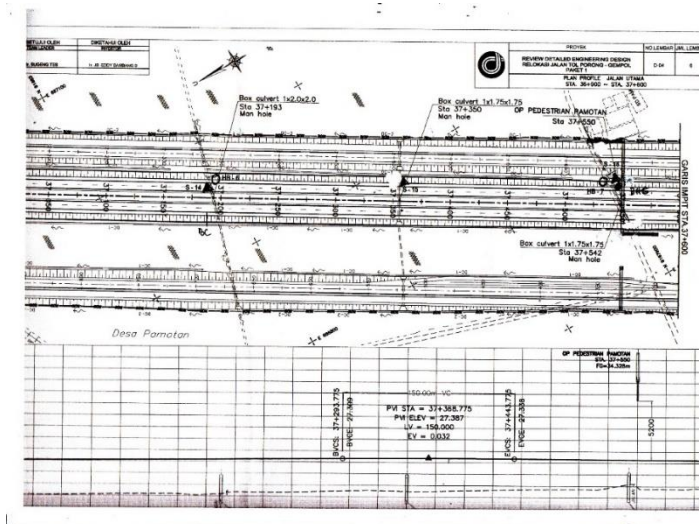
2 Denah lokasi proyek mulai BH - 4 (STA 35 + 060)
